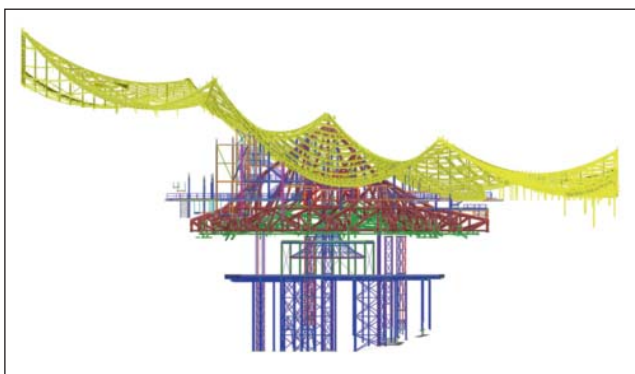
Gesamtmodell mit Montagetisch, Saaldachfachwerk (braun), Decke Innenschale (grün) mit dem Abluftbauwerk (rot) und dem Reflektor (blau), Gebäudedach (gelb), Technikstahlbau (mehrfarbig zwischen Saaldach und Gebäudedach)
